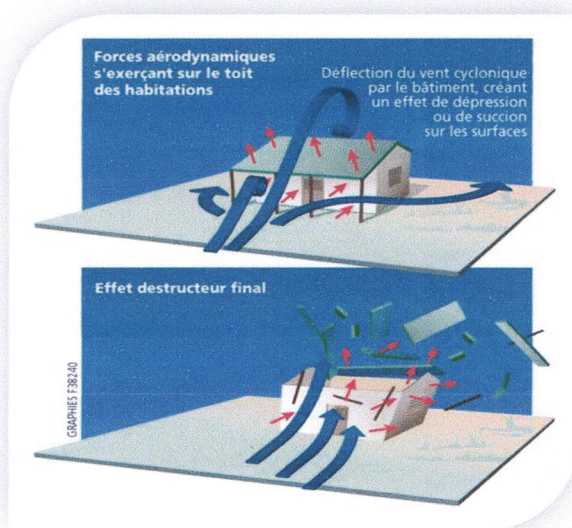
image montre la protection de bâtiment contre le vent
